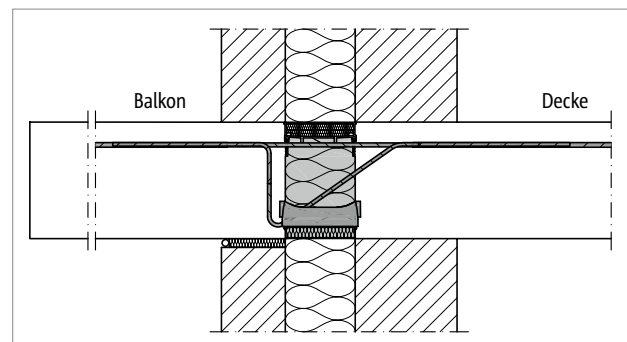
Schöck Isokorb® XT Typ K: Anschluss bei zweischaligem Mauerwerk mit Kerndämmung
